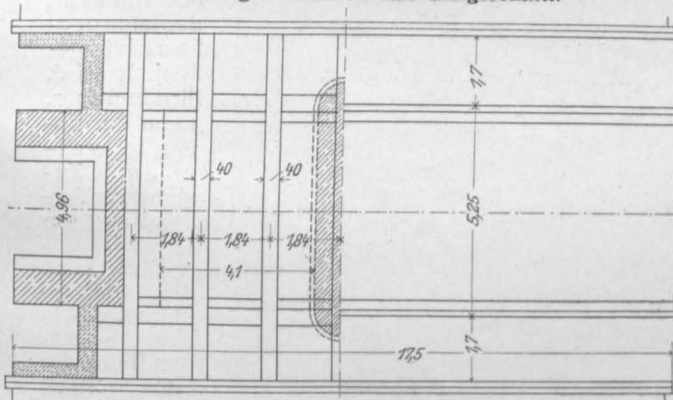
Grundriß und Aufsicht auf die Fahrbahn.
